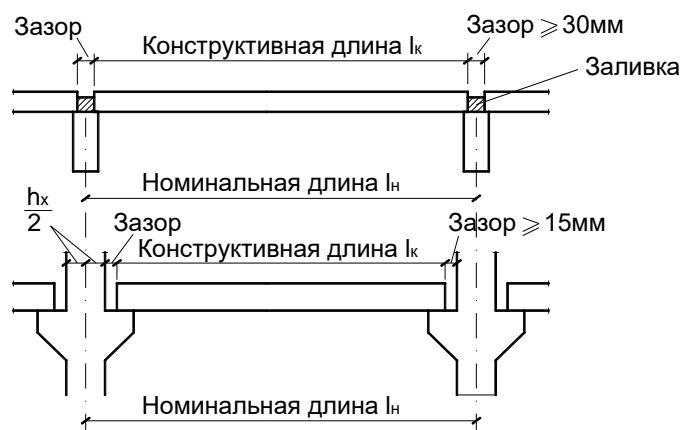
Номинальные и конструктивные размеры сборных элементов:
